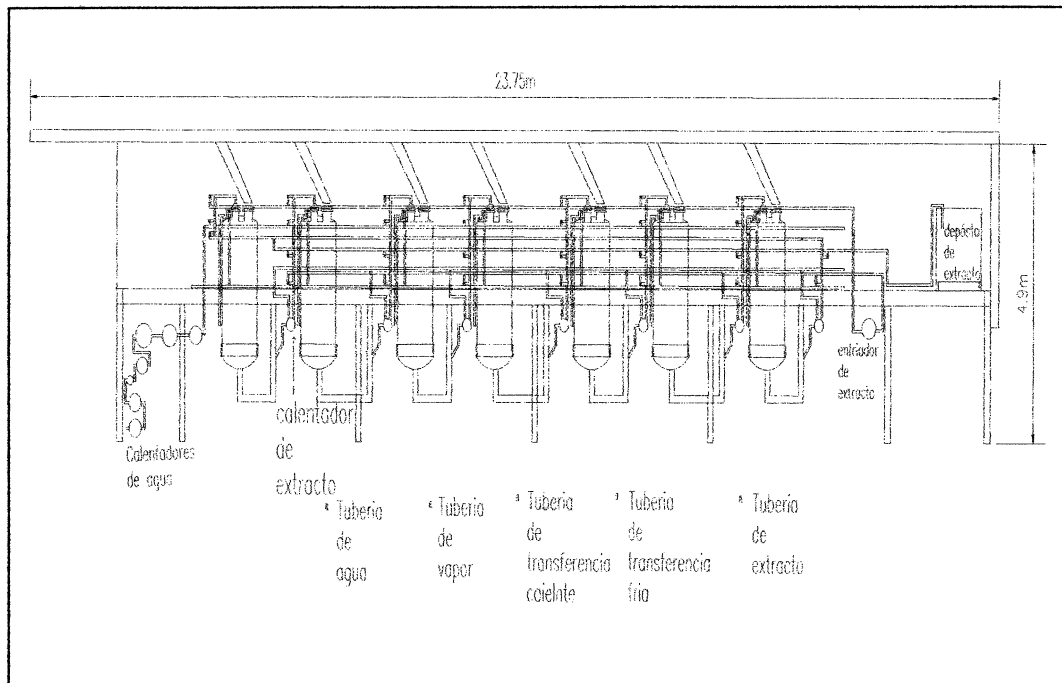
Plano del área de extracción de la planta piloto vista en planta
